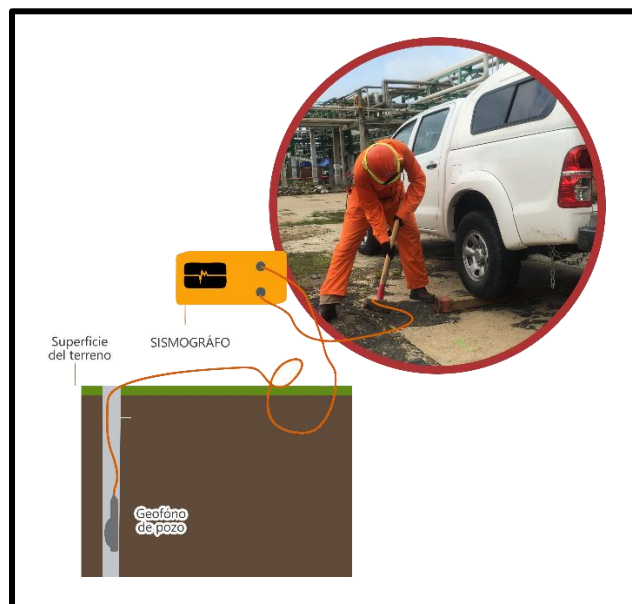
Ilustración esquemática del ensayo sísmico de Downhole (Adaptada de Crice, 2002).
